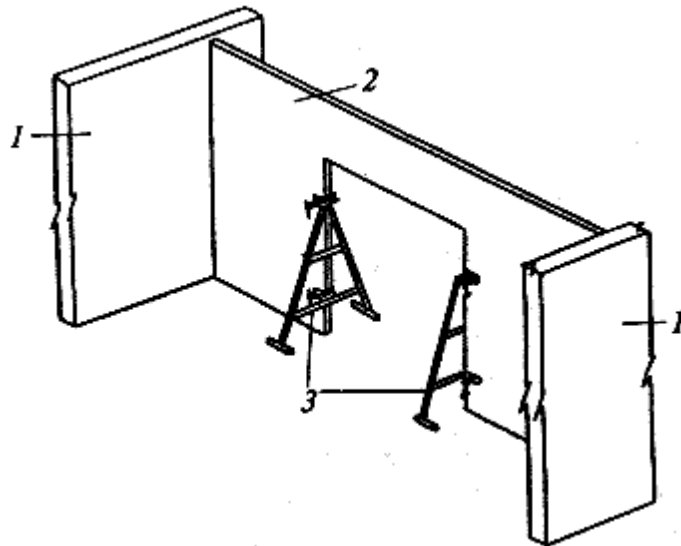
Схема тимчасового кріплення залізобетонної перегородки
